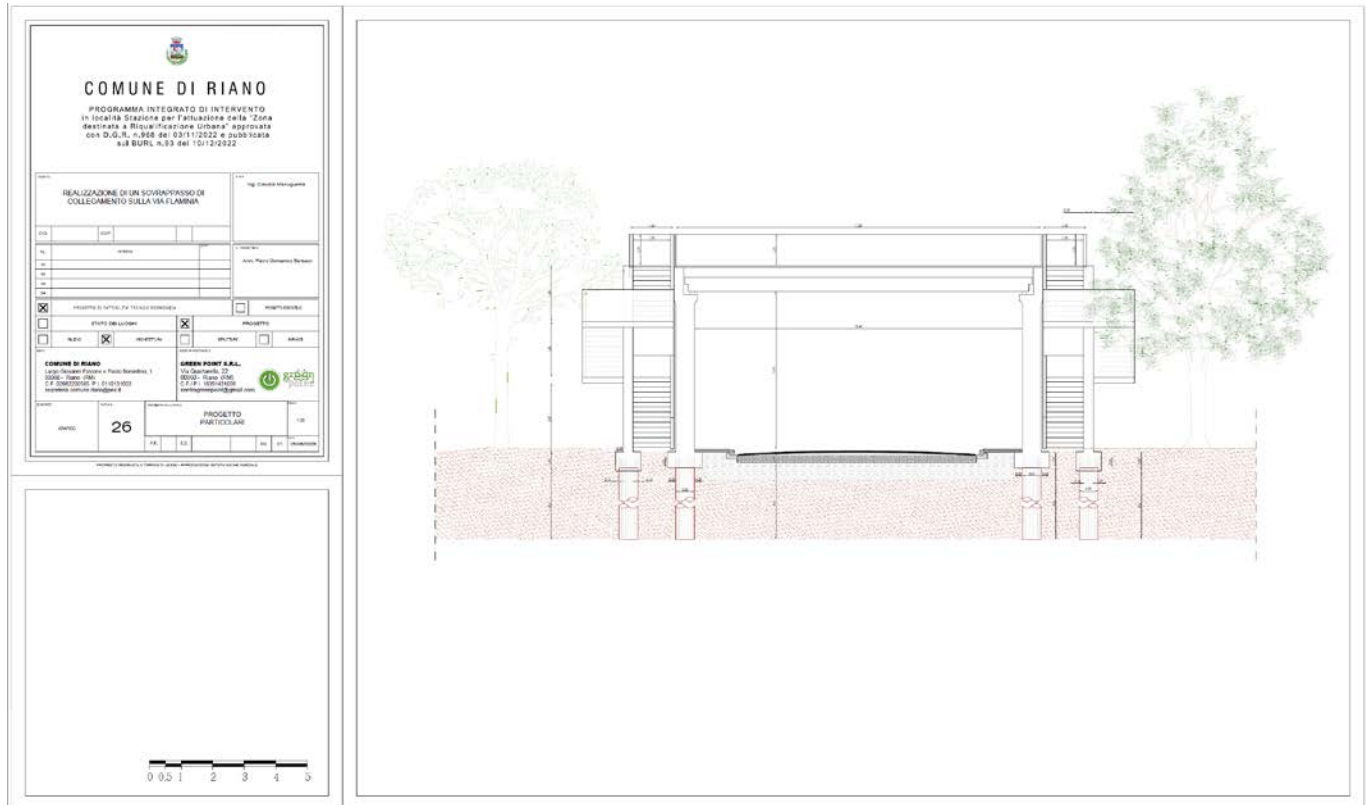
A24 Rev02: particolari costruttivi e prospetto in scala
